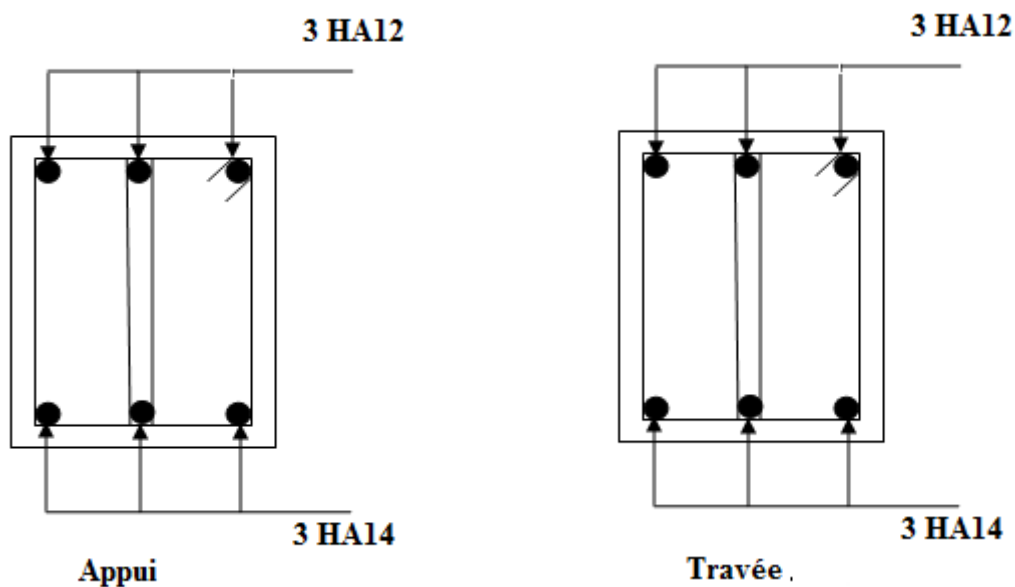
Schéma de ferrailage des poutres principales pour la terrasse
